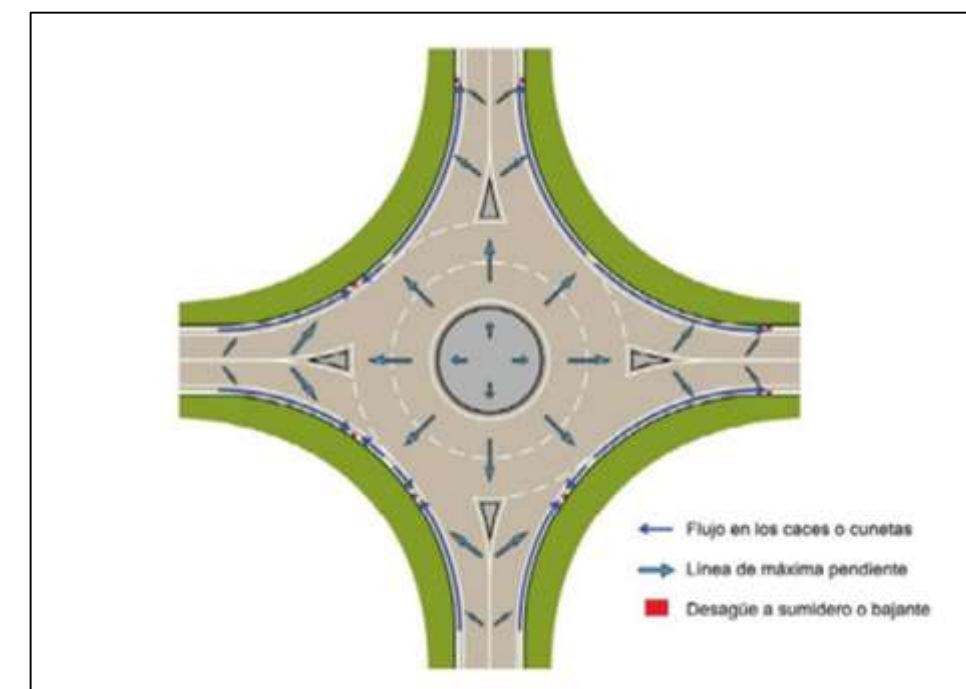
Pendientes de la glorieta y elementos de drenaje (norma 5.2-IC Drenaje Superficial)
